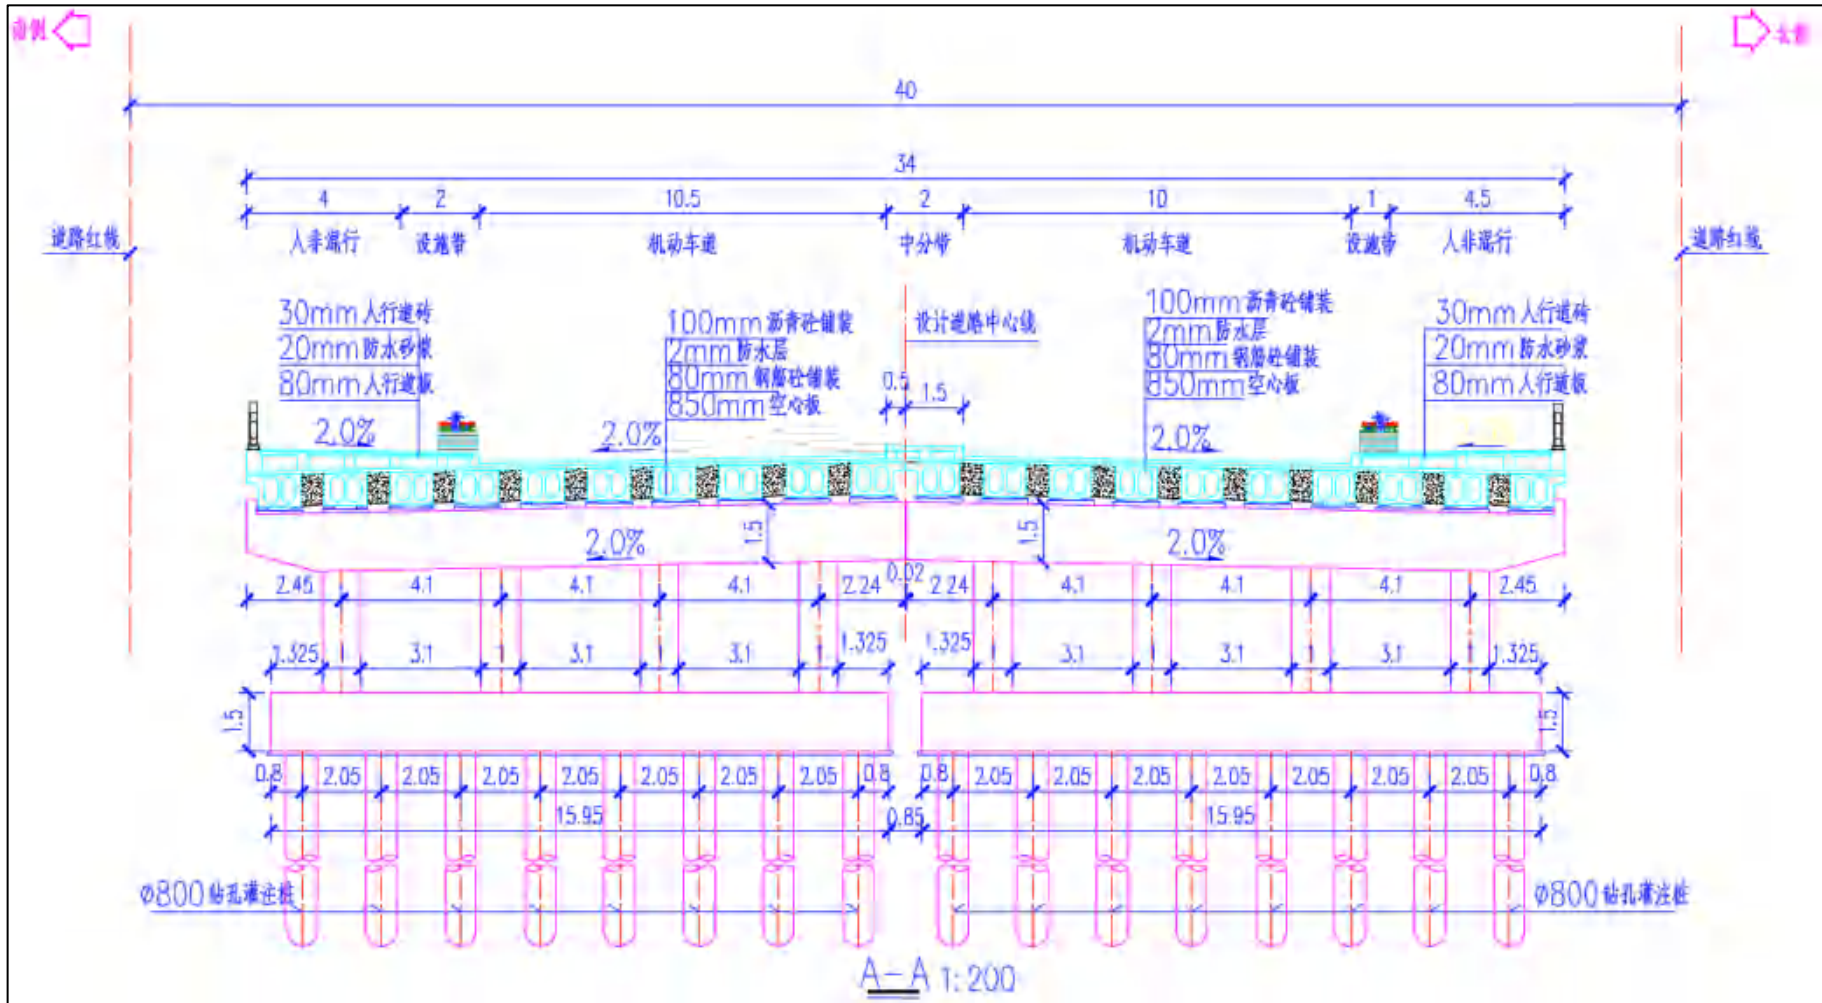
小元六港桥涉水桥墩 (K9+693.98) 横断面布置图
